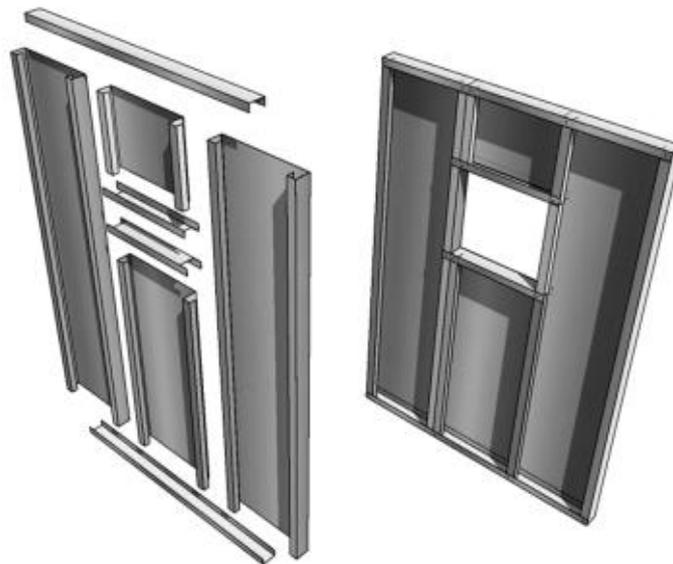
Fabricação do módulo metálico do Sistema Steel Panel Quick House
